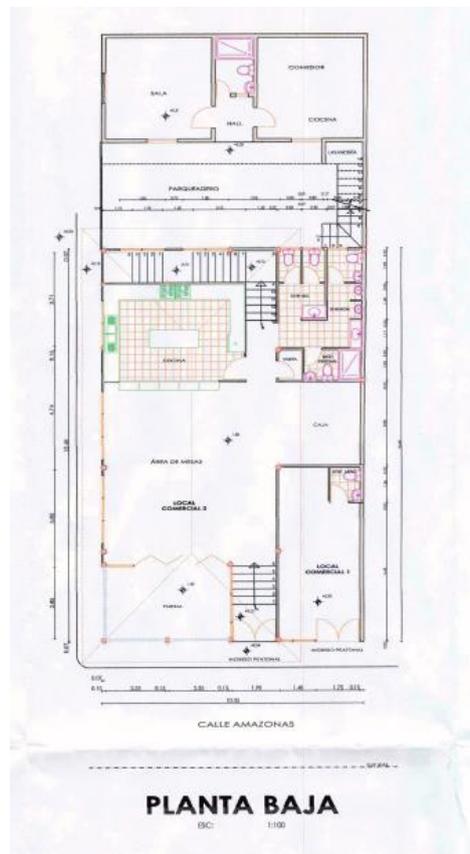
Composición Funcional Planta Baja- Propuesta.
